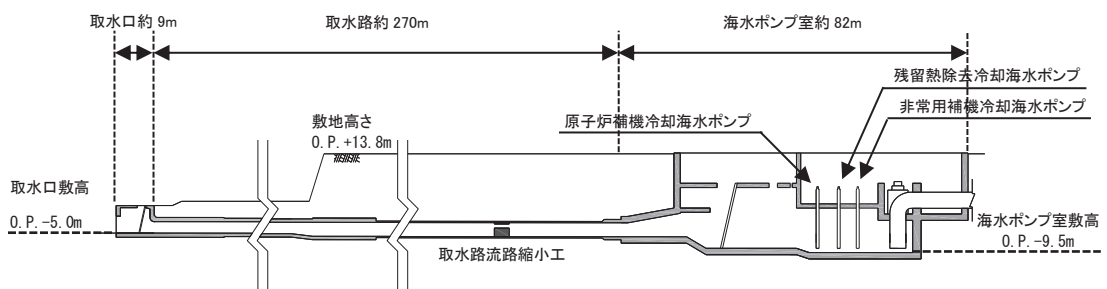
(1) 水路縦断面図 (第 1 号機取水路 A-A 断面図)
